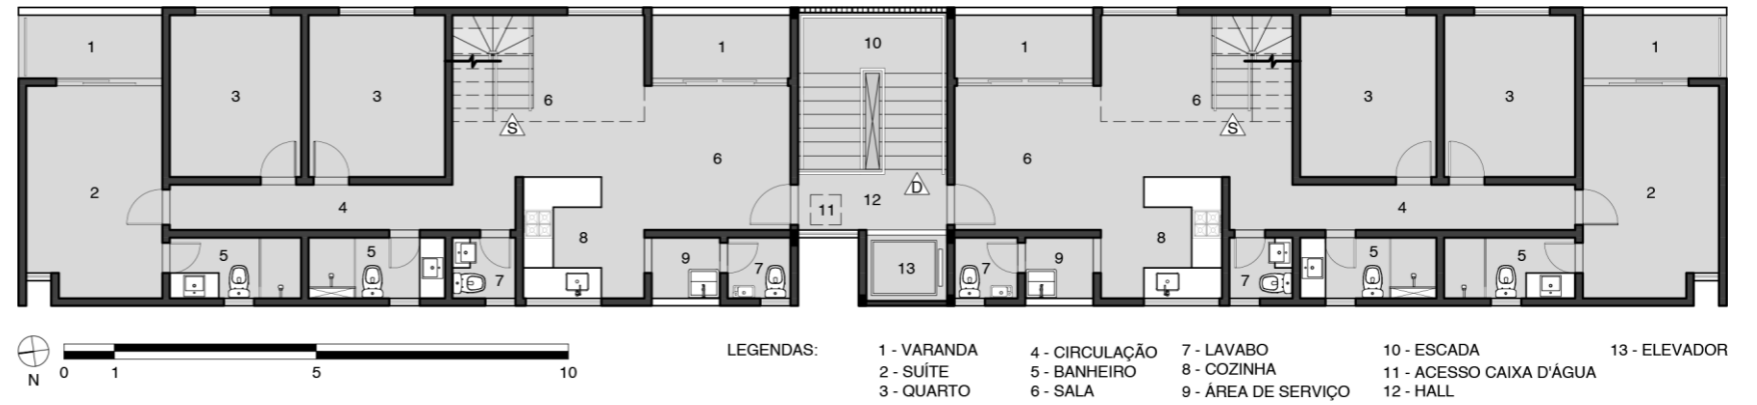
Planta do quarto pavimento do Residencial Zíder
